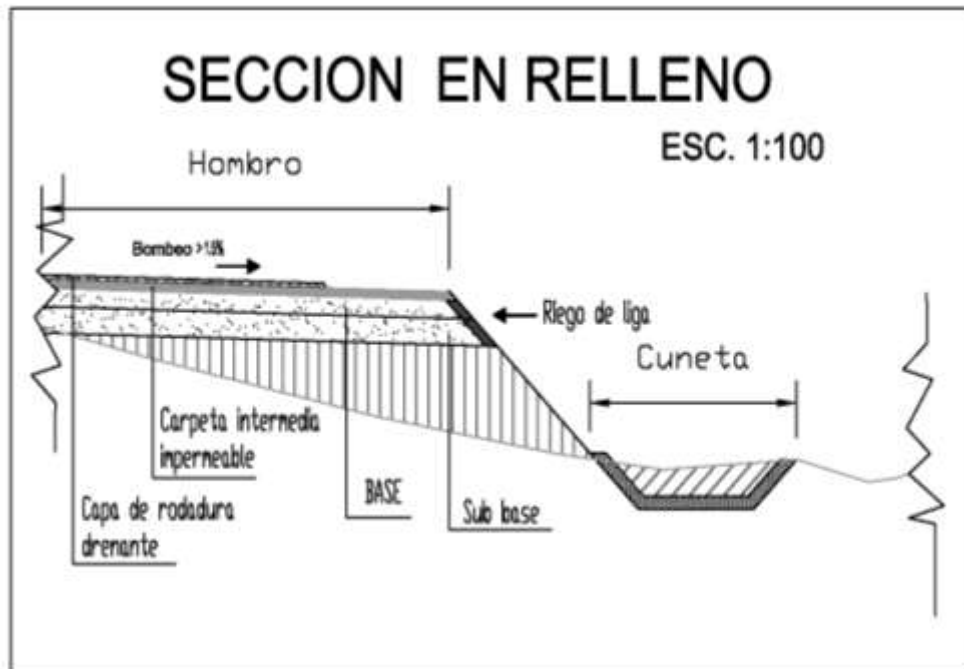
Sección Transversal en Relleno de un Pavimento con Capa de Rodadura Drenante.
